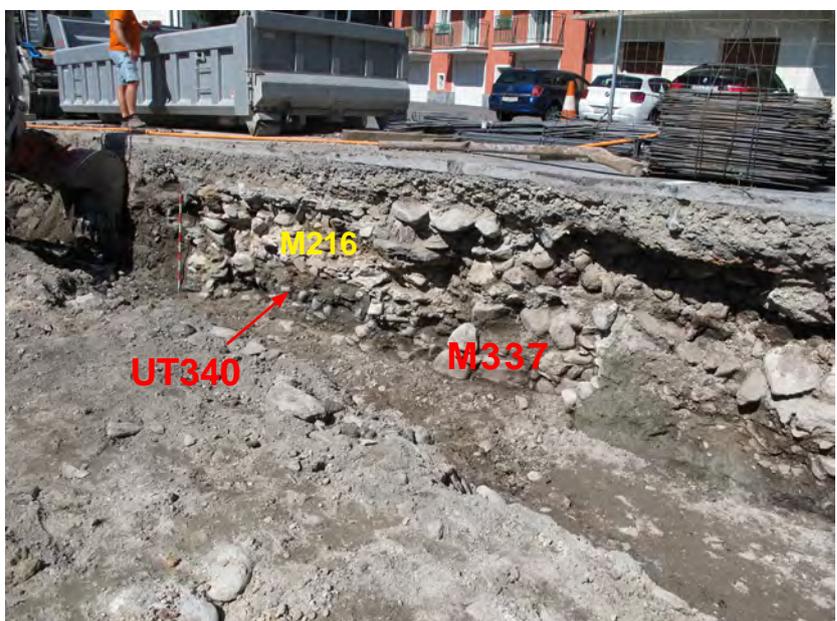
St-Maurice, Lavigerie. Tranchée eaux usées, vue du sud-ouest depuis le toit du garage (alors construit).
